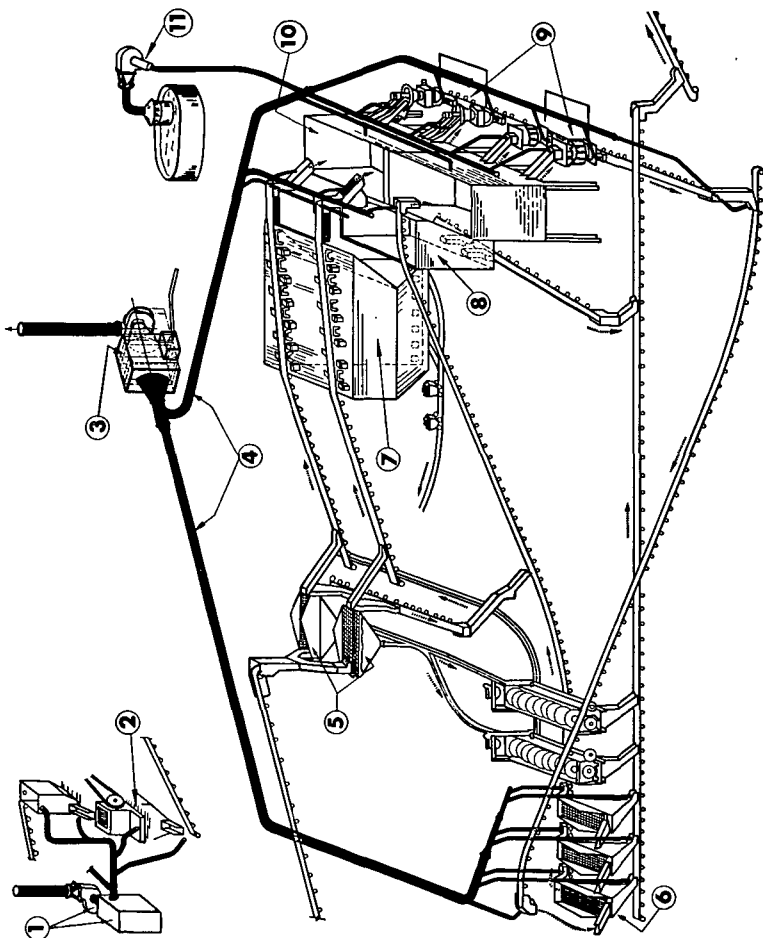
Schéma d'une installation de dépoussiérage dans des halles de concassage.
